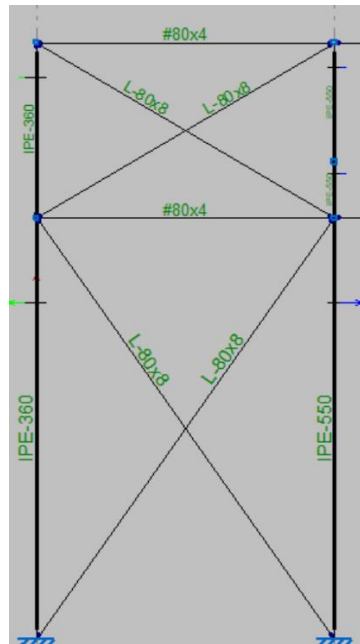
Cruz de San Andrés con detalle de elementos constructivos.
